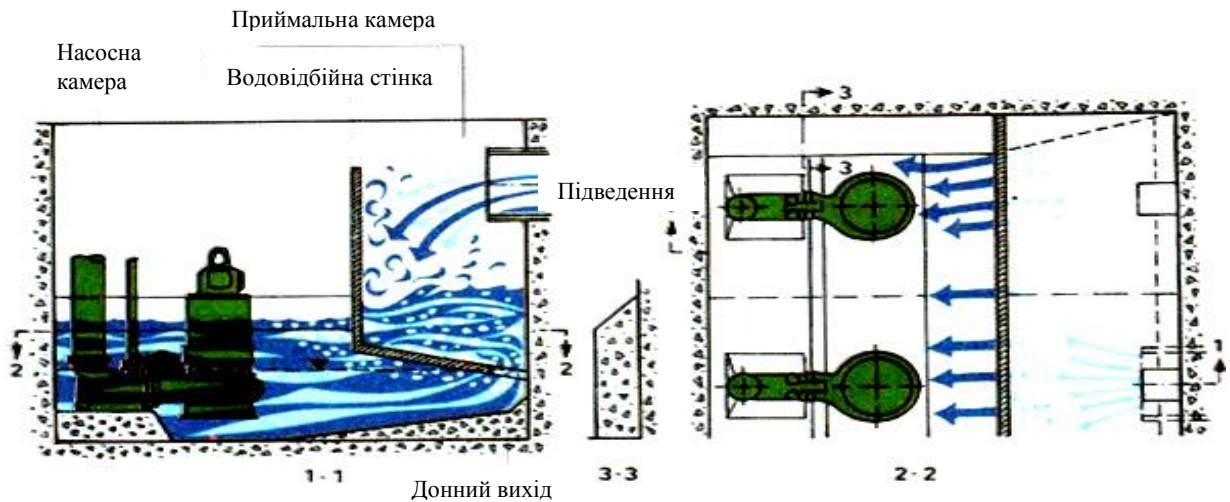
Принципова конструкція насосно-приймального резервуара
